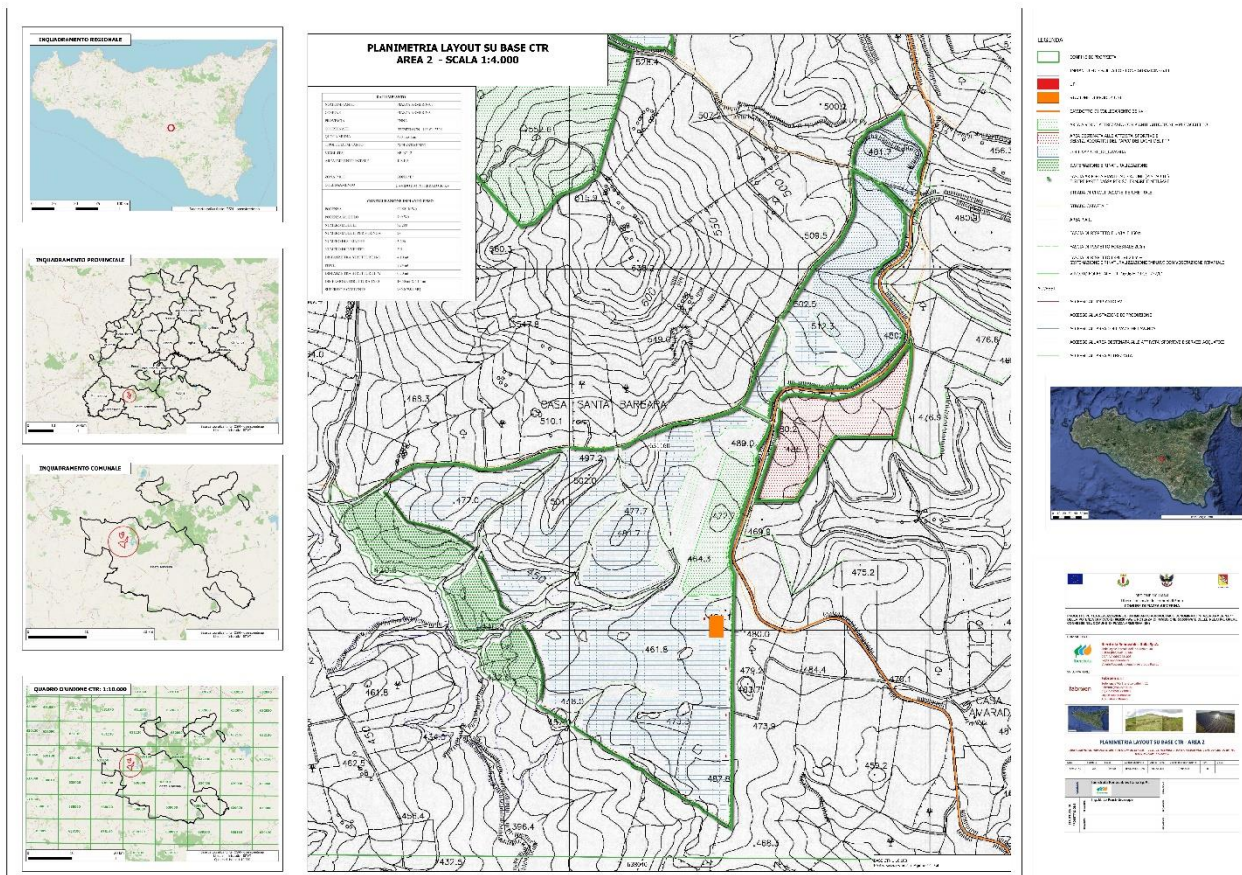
Planimetria layout – Area 2: Parco fotovoltaico area di intervento.
